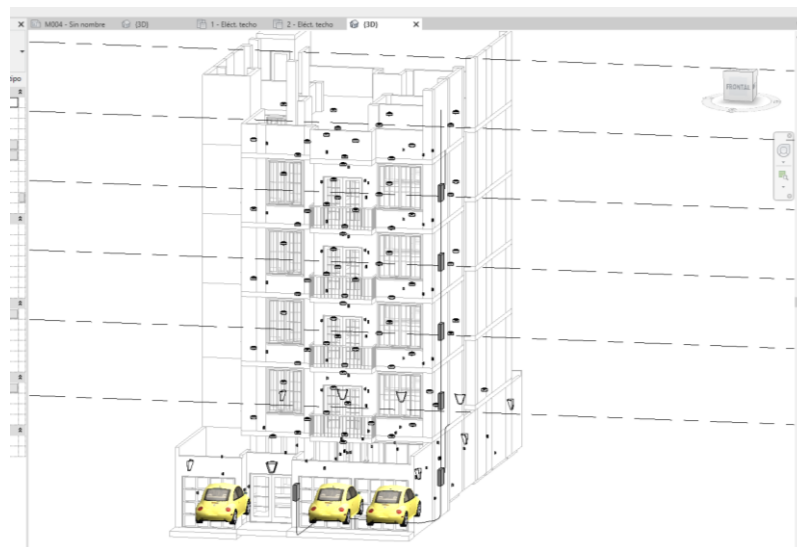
Vistas 3D de las instalaciones eléctricas
